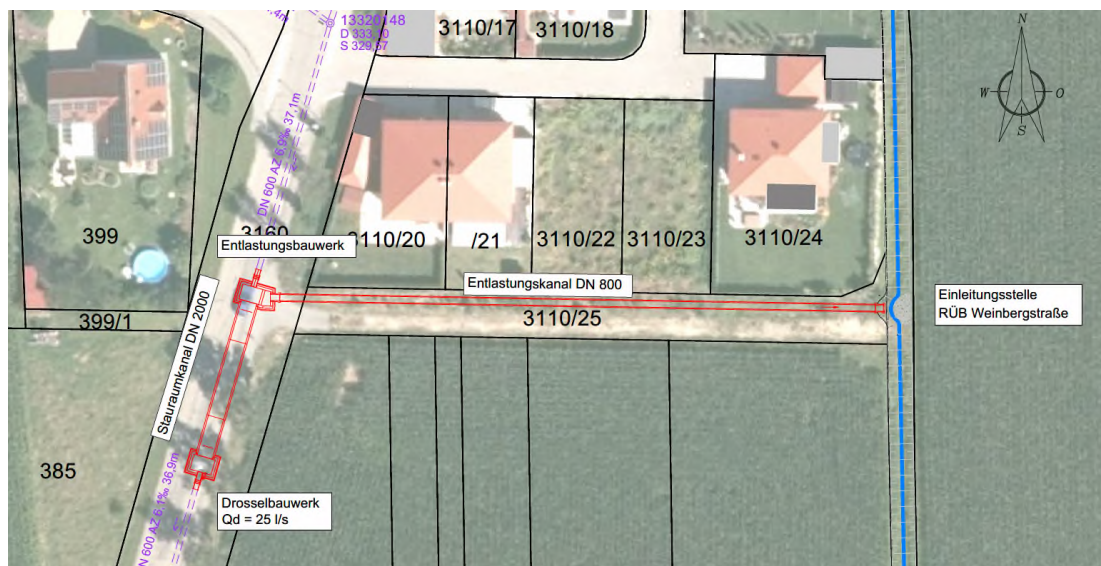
Lageplan RÜB Weinbergstraße mit aktuellem Luftbild
